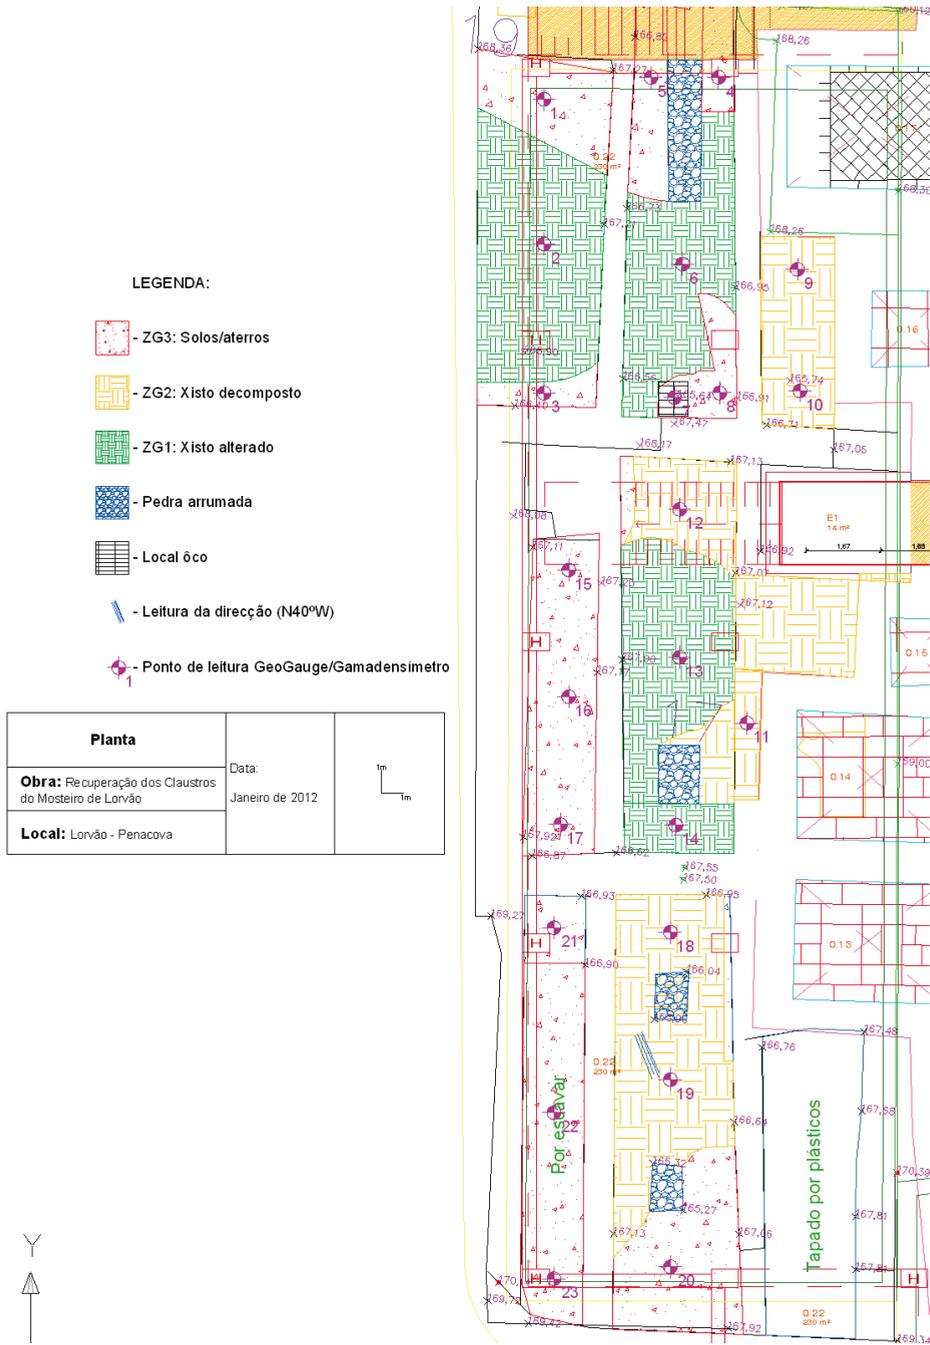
Planta de zonamento geotécnico dos terrenos, após as escavações arqueológicas que puseram a descoberto os muros.
